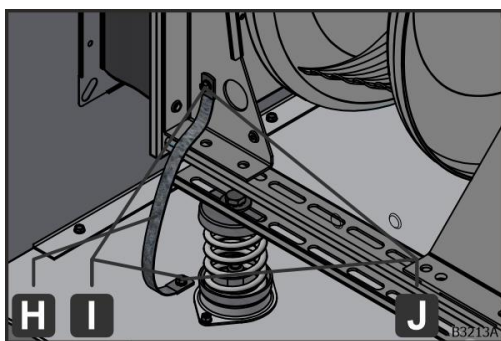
Ruban plat de mise à la terre pour le plancher
